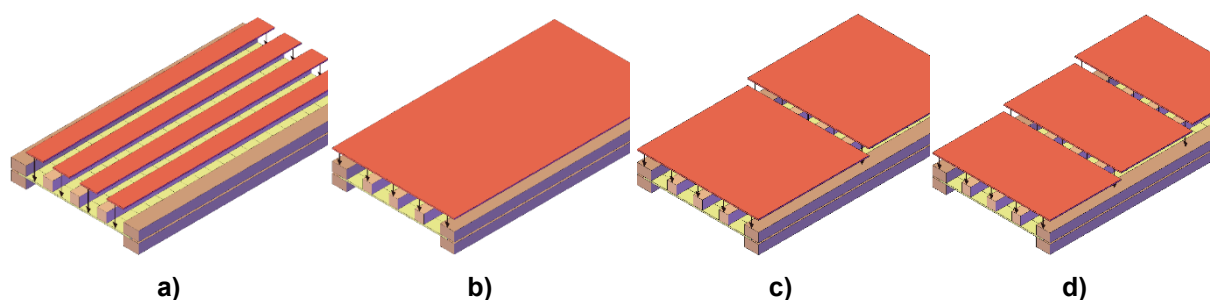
Hipóteses de reforço a colocar na face inferior do pavimento. a) Pranchas de introduzidas no soalho entre vigas. b) Painel único introduzido na face inferior das vigas. c) Divisão do painel de reforço em 2. d) Divisão do painel de reforço em 3.
